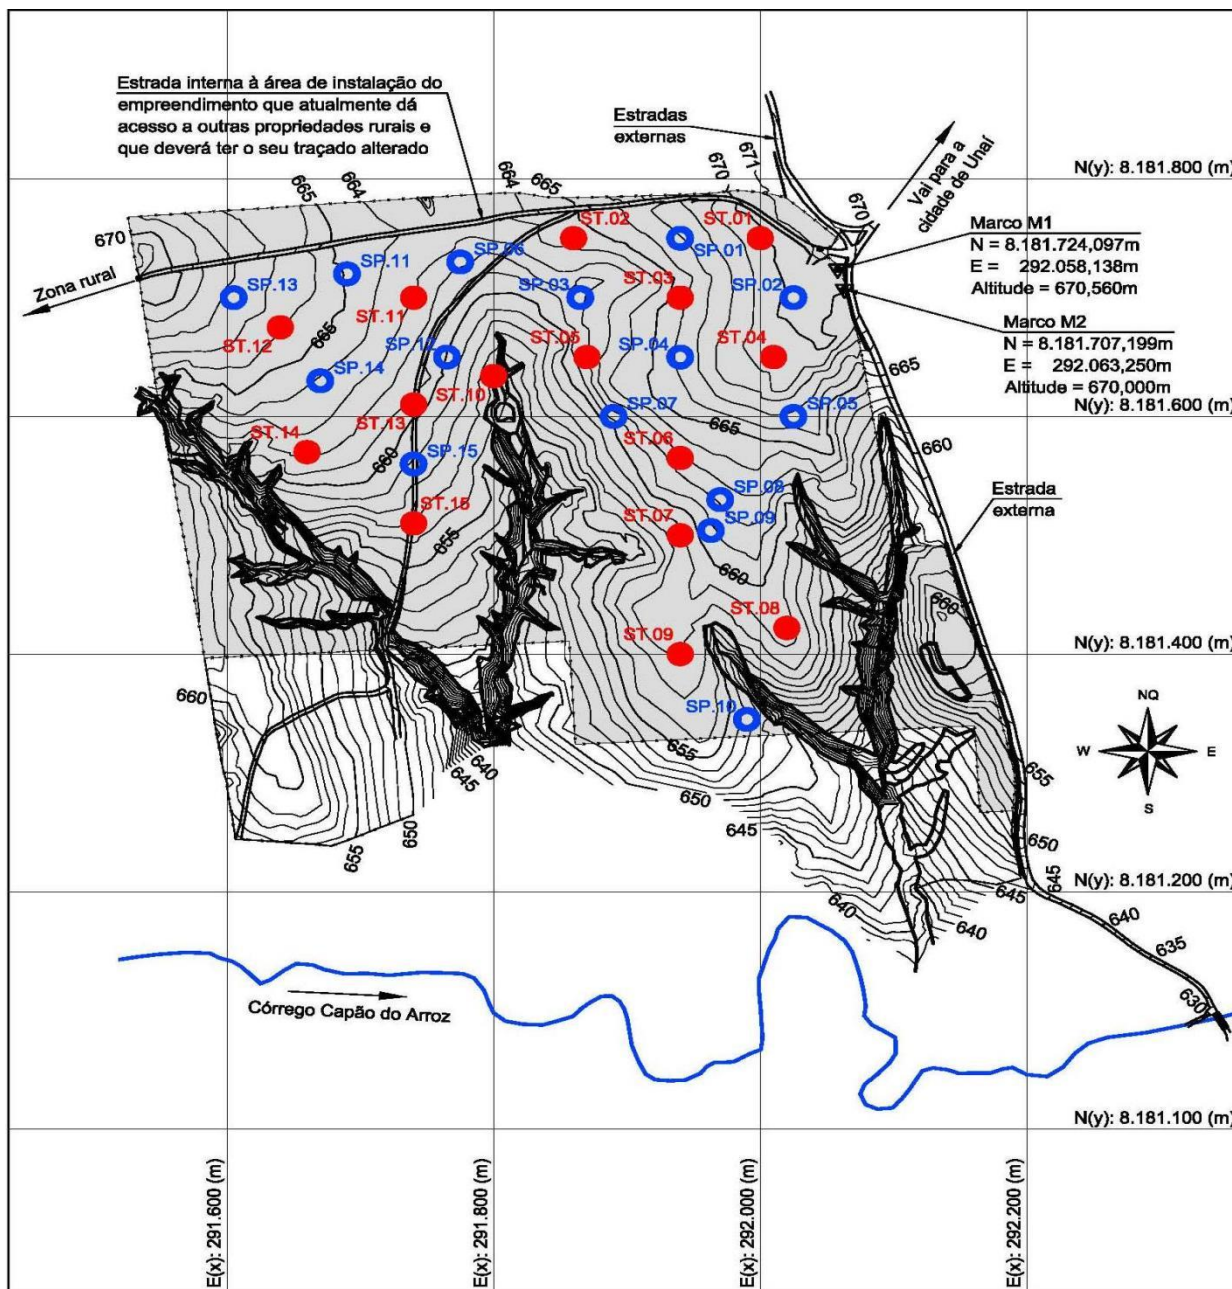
Planta de locação dos furos de sondagem a percussão SPT (furos SP) e dos furos a trado (furos ST) executados na área.
